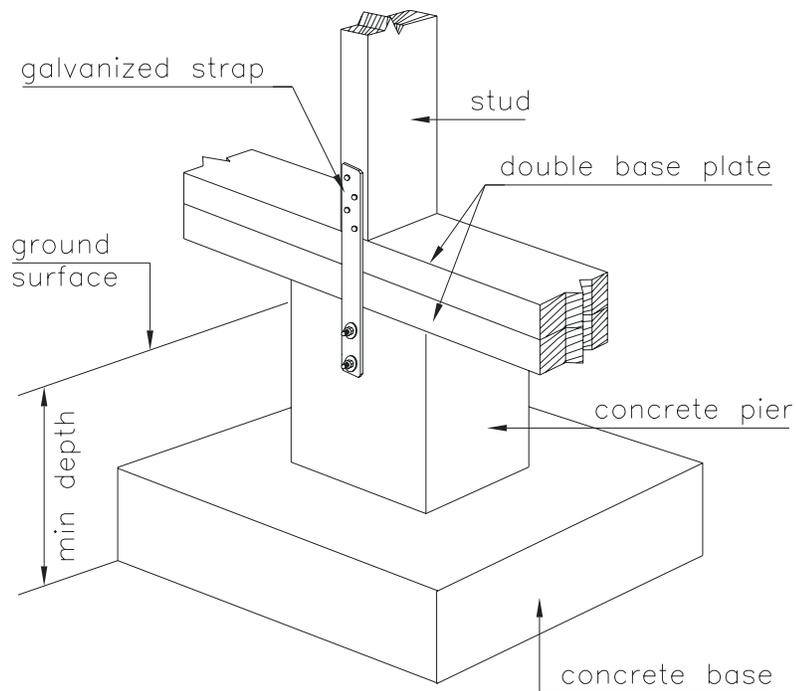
Ancrage des fondations – Jonction poteau/fondation
